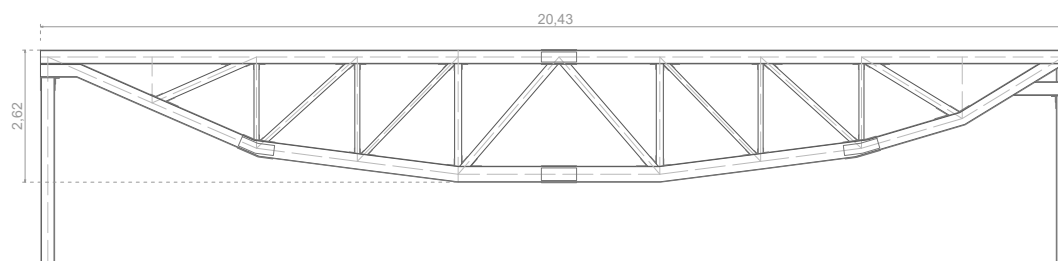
Alzado cercha Gimnasio Maravillas. E: 1/150.
